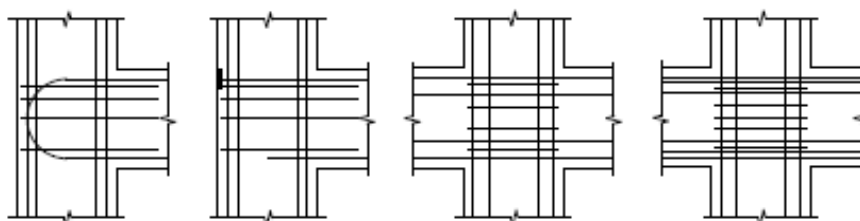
Pormenorização da armadura das ligações viga-pilar (Roeser, 2002)
